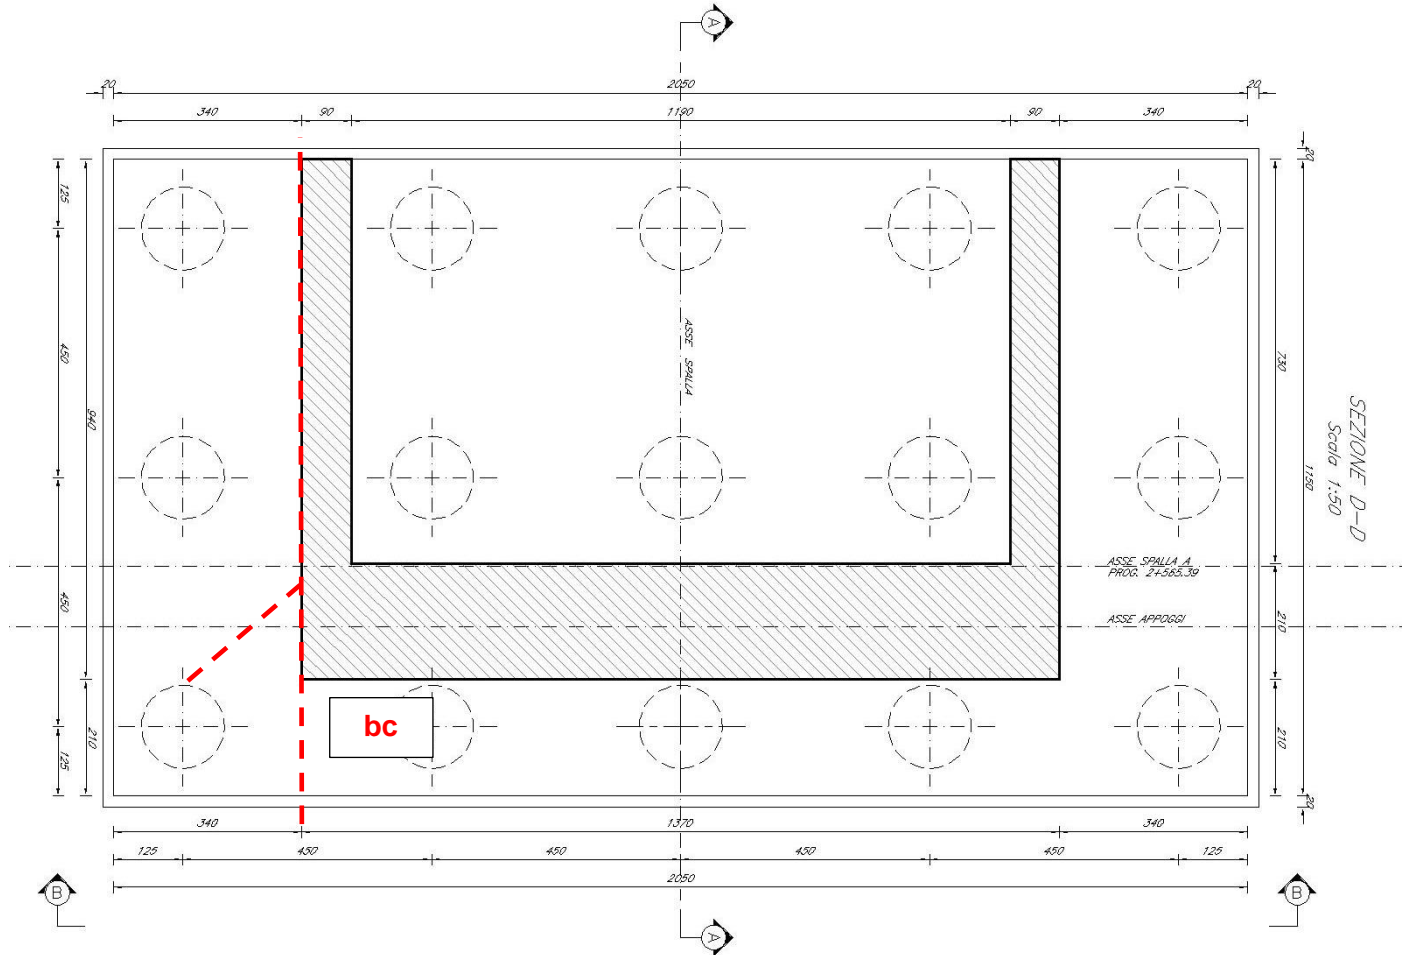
Plinto di fondazione – Mensola laterale– larghezza della sezione collaborante
